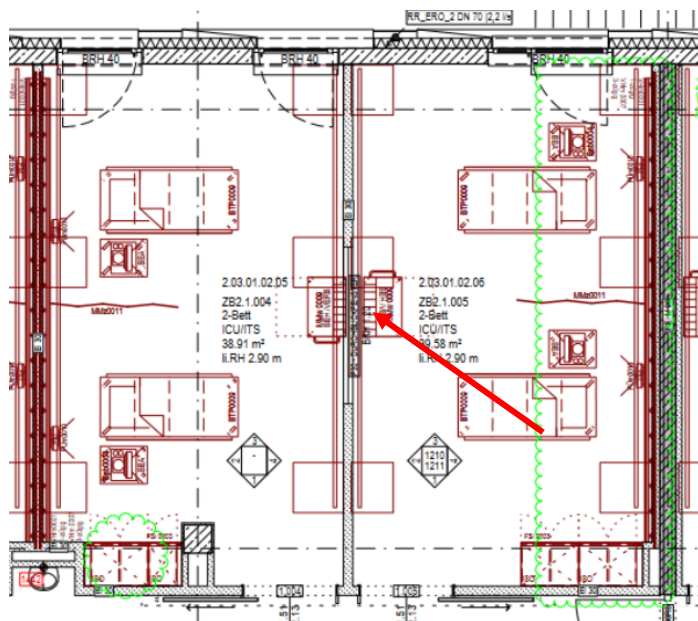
Planausschnitt 1. OG – Fenster ITS
